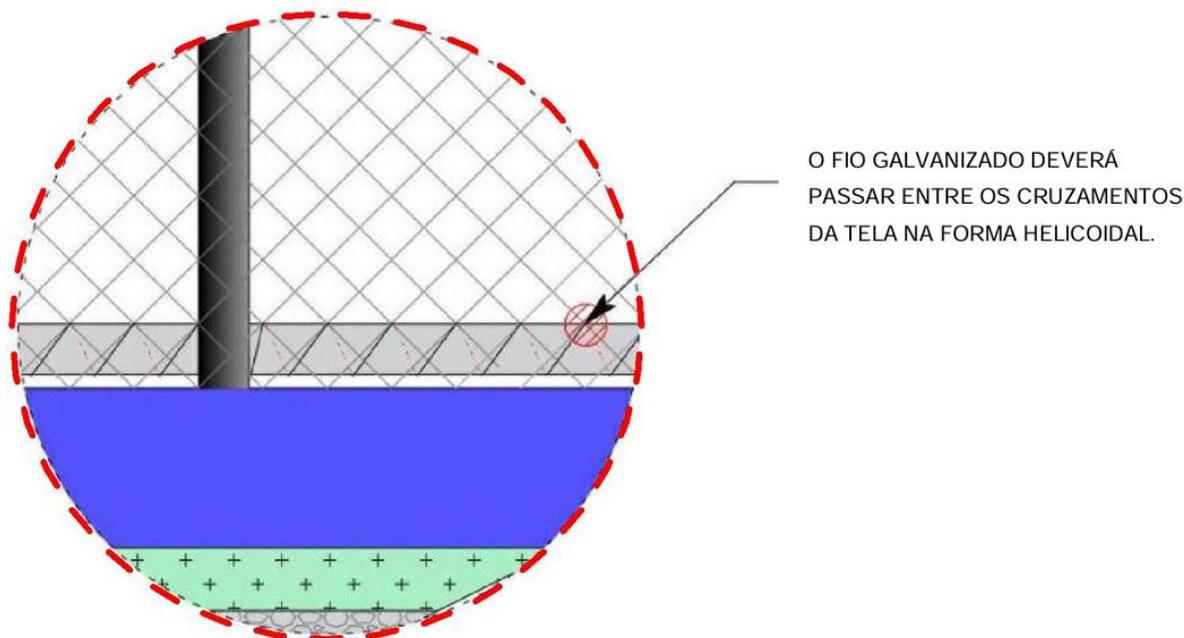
Detalhe da fixação das telas (Fonte: Autor/2023)
